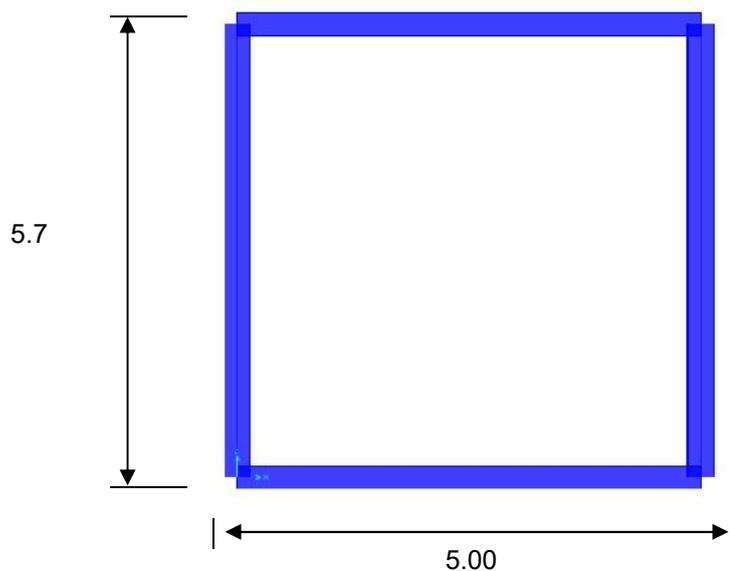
Vista de pórtico principal de túnel con cimbras metálicas
